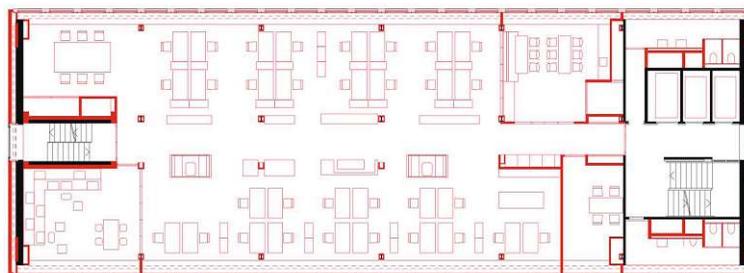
Der neue Grundriss ermöglicht flexible Nutzbarkeiten.
